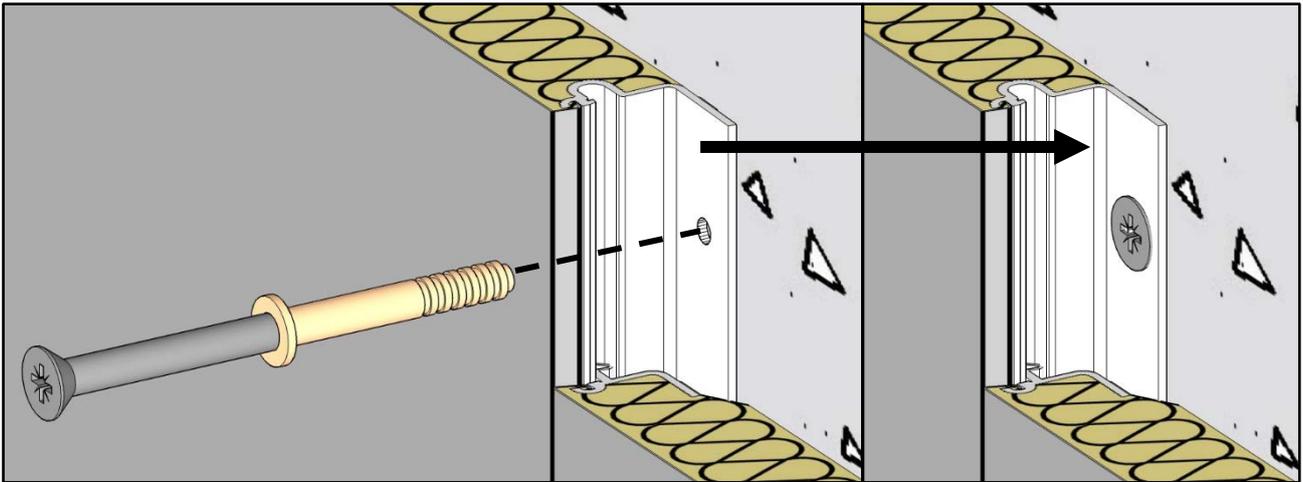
Principe d'emboîtement du profil joint debout MYRAL
